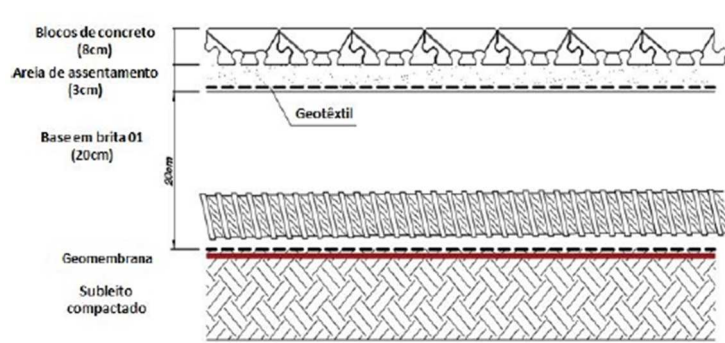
Secção longitudinal da estrutura do pavimento (Ono et al., 2017).
